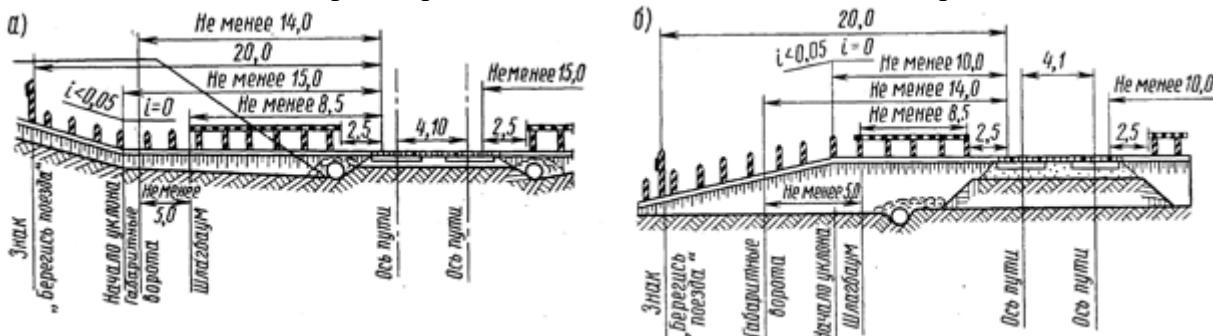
Продольный профиль железнодорожного переезда: а – в выемке; б – на насыпи
